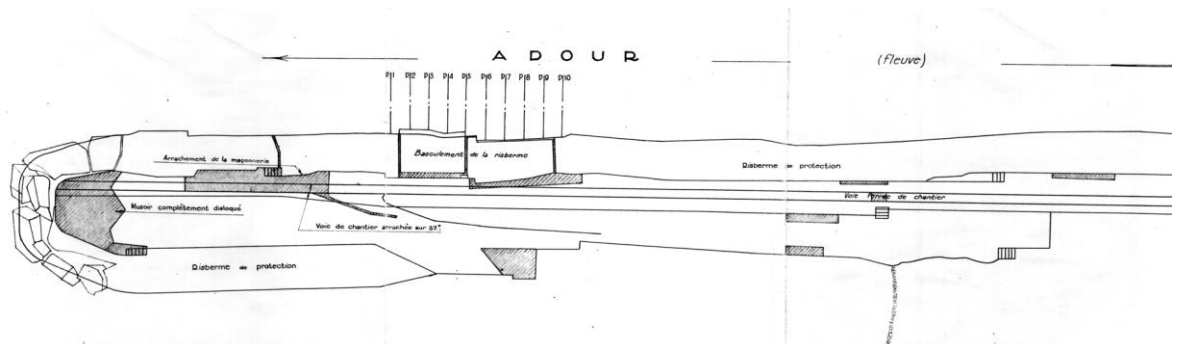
plan masse de l'ouvrage avec les dommages causés par la tempête de 1958
